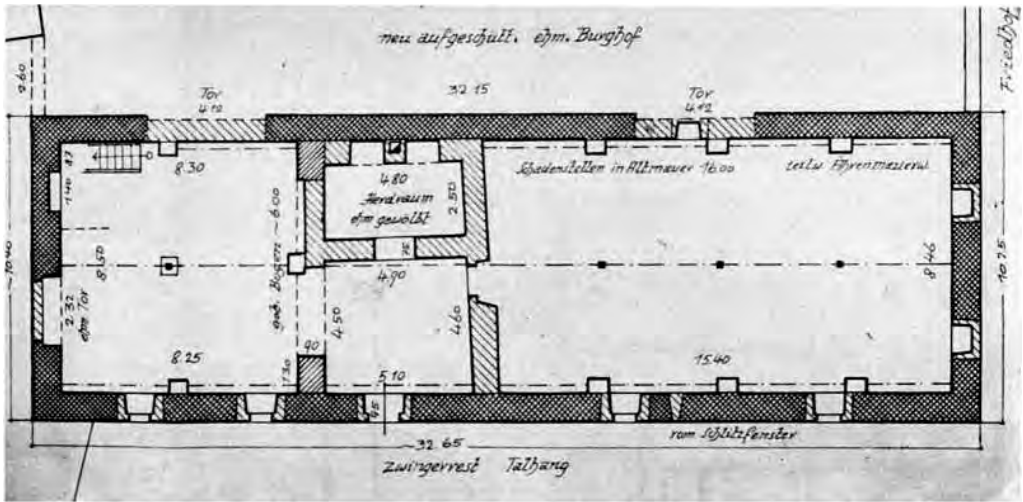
Grundriss des „Kasten“. Plan von Prof. Klaar aus 1969
